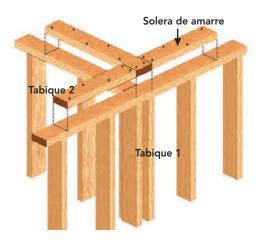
16: Solera de amarre o sobresolera que une un muro perimetral con un tabique interior.
